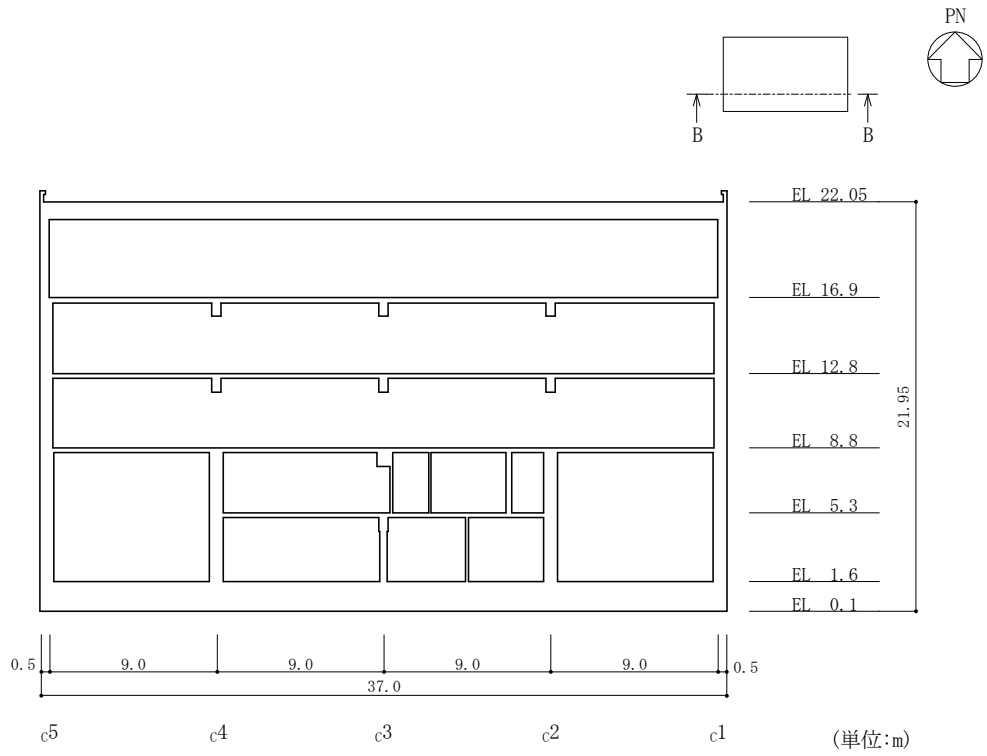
(2) 制御室建物の概略断面図 (B-B 断面, EW 方向)
